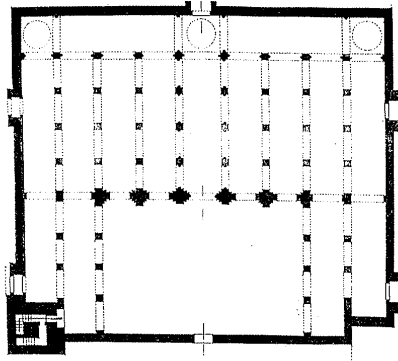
مسقط أفقى لجامع حسان بالرباط.
